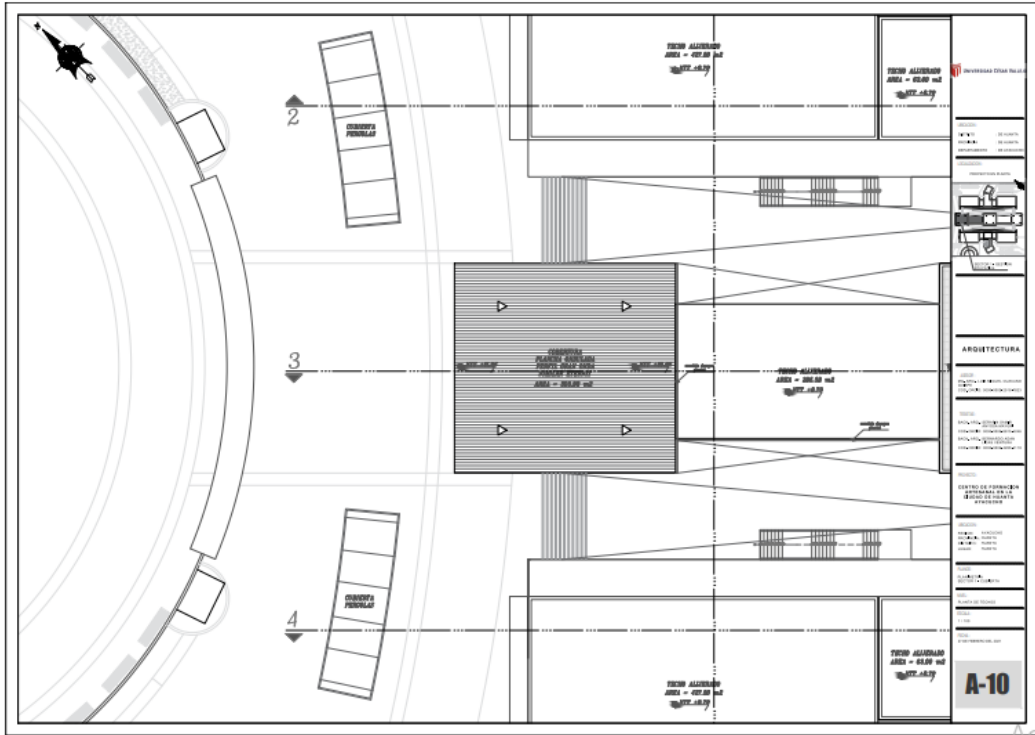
Planimetría de techos del sector 1. Escala 1/100.
